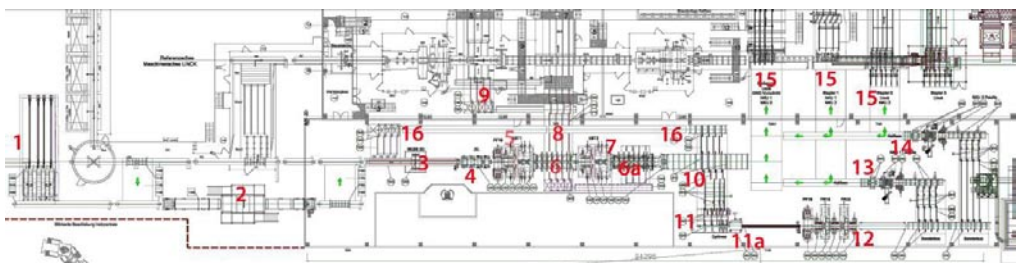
Plan des gesamten Sägewerkes (Quelle: Dietz)
